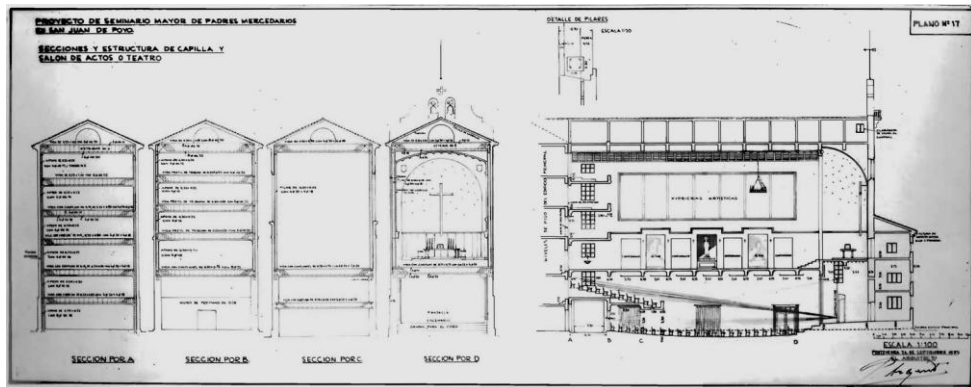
Secciones y estructura de Capilla. Fuente: Archivo Provincial.
